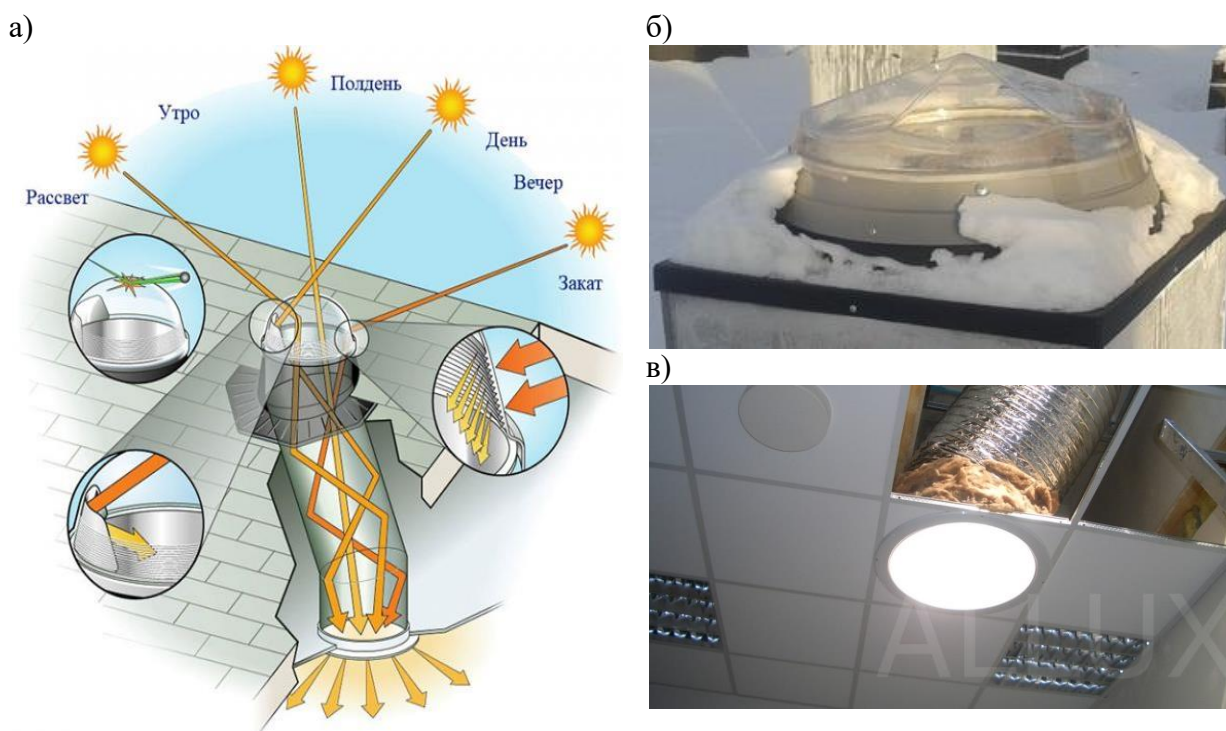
Устройство полого трубчатого световода: а – схема конструкции; б – внешний вид светособирающего купола на крыше; в – внешний вид рассеивающего устройства в помещении
